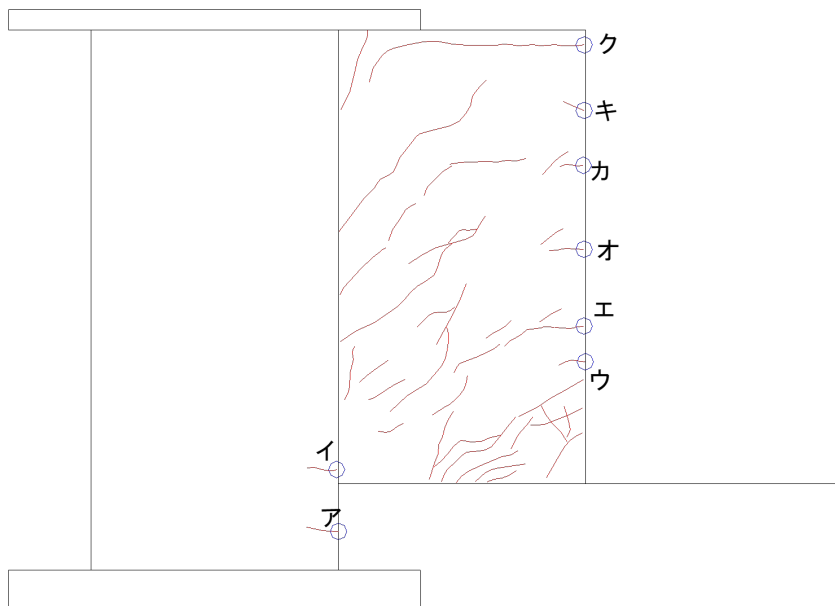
柱ひび割れ幅測定位置(試験体 B-1 負荷荷)
